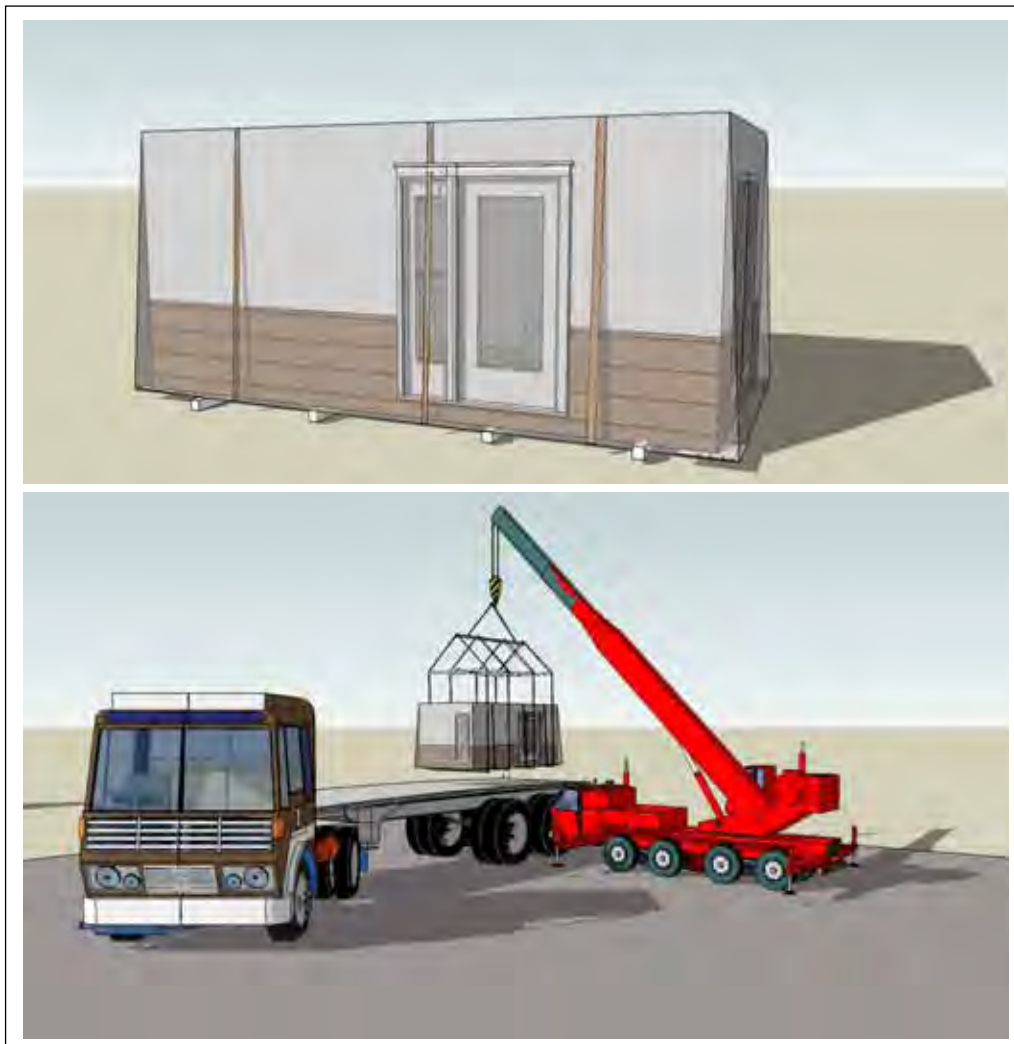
Embalado e izado del módulo. Fuente: Elaboración propia 2008
